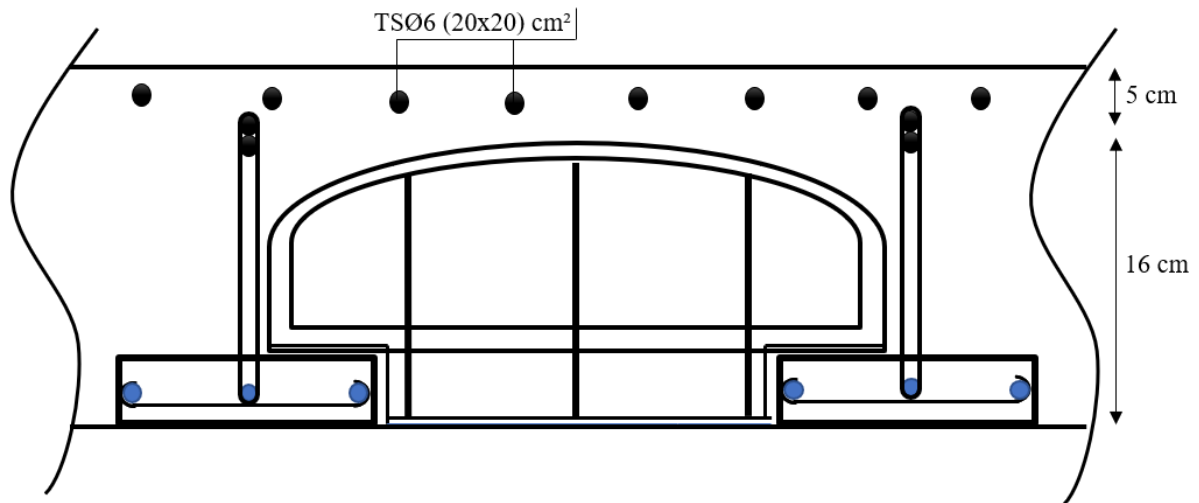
Schéma de Ferrailage du plancher corps creux.
